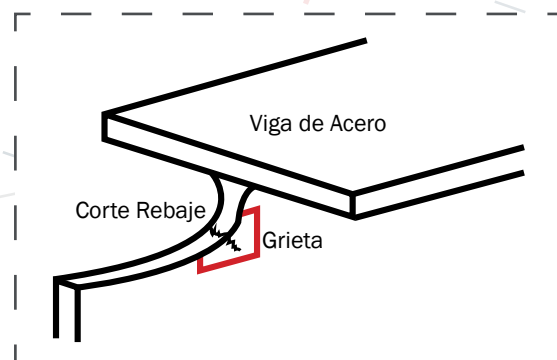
Grietas en rebajes en vigas de acero estructural después del galvanizado
